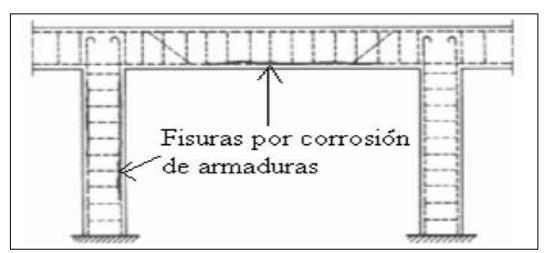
Fisuras por corrosión de la armadura de refuerzo. (Toirac, J., 2009).
